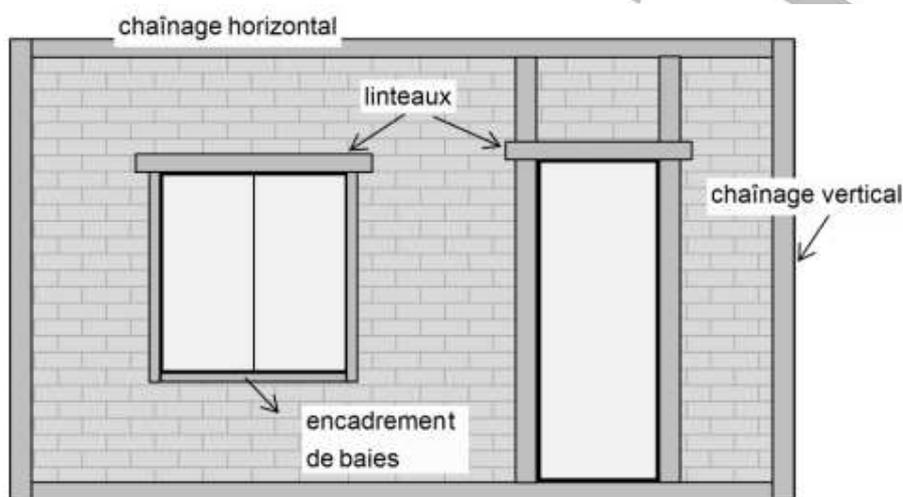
exemple des chaînages verticaux et horizontaux
